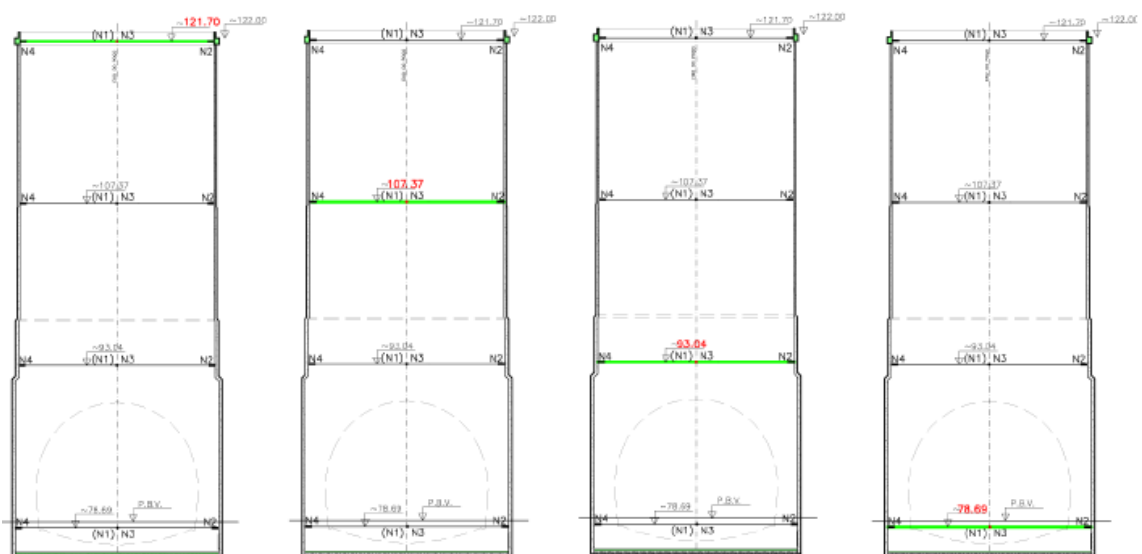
Esquema de implantação das seções de convergência no poço de ventilação (adaptado EPOS, 2010).
